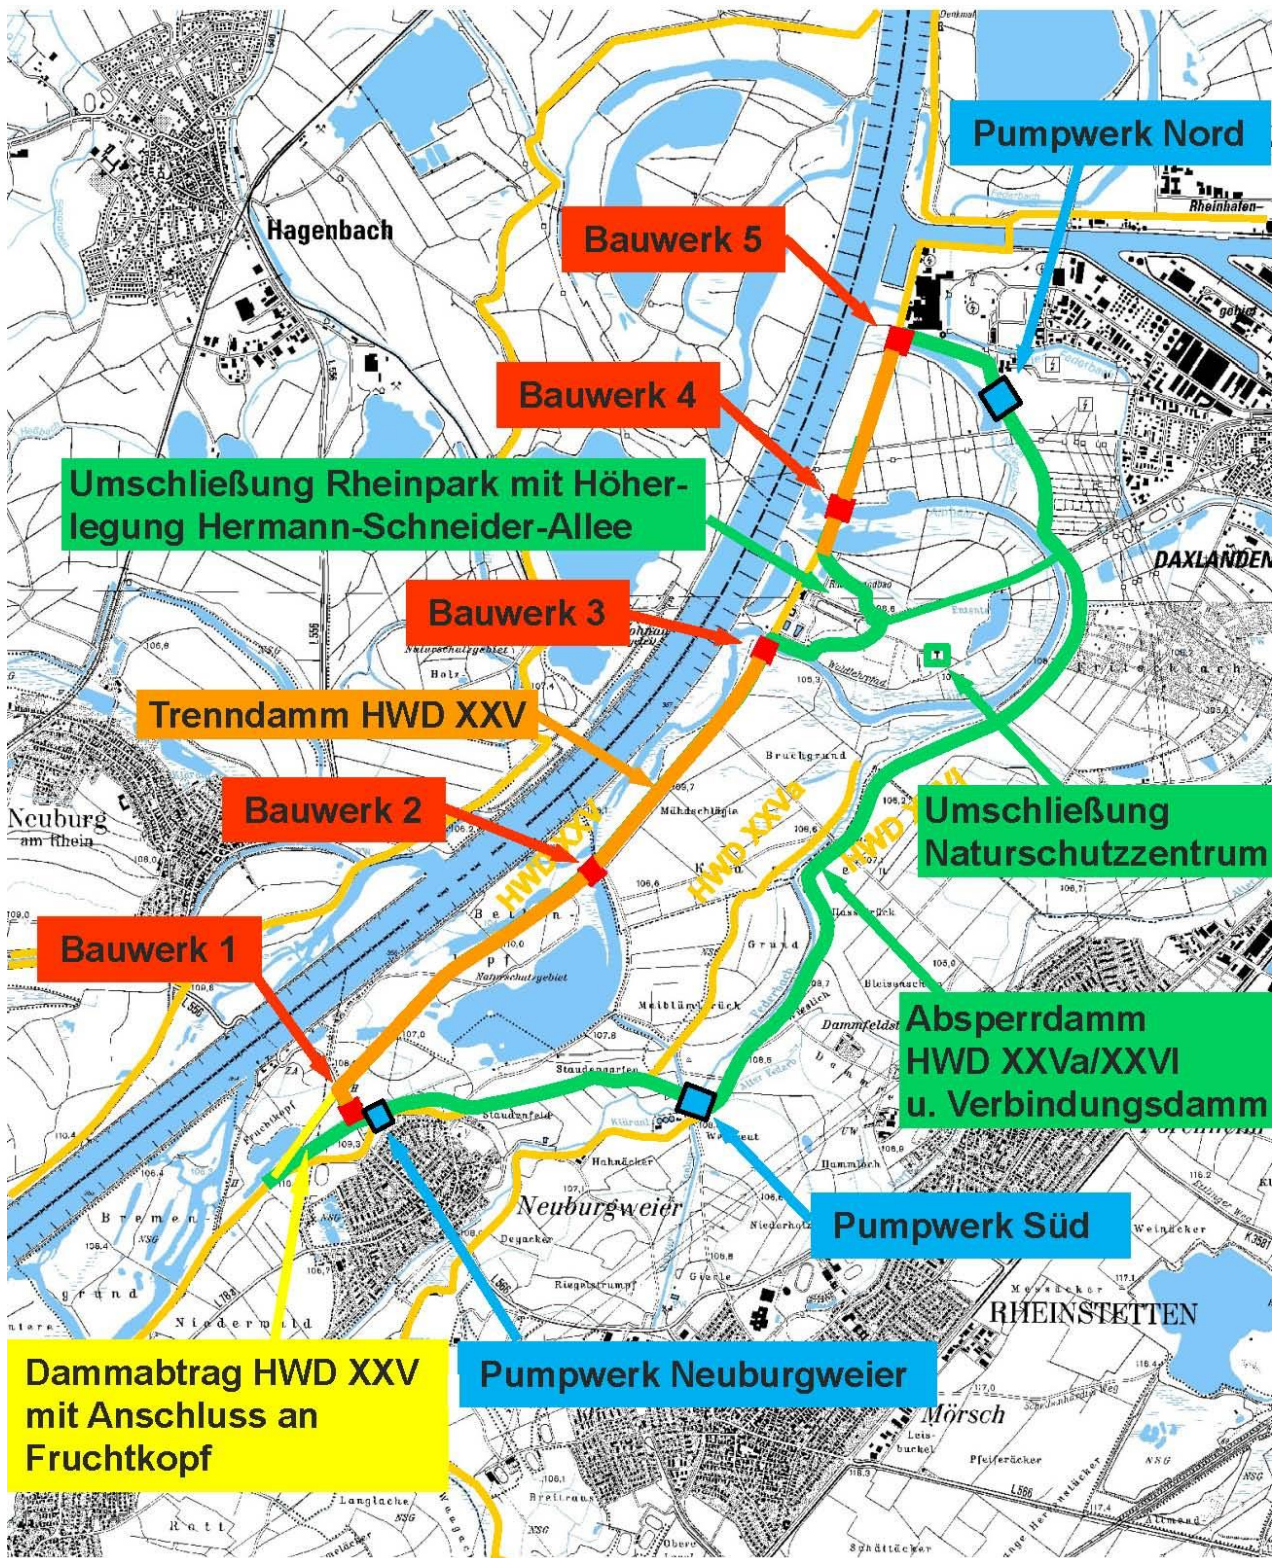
Übersichtslageplan mit eingereicherter Planung
